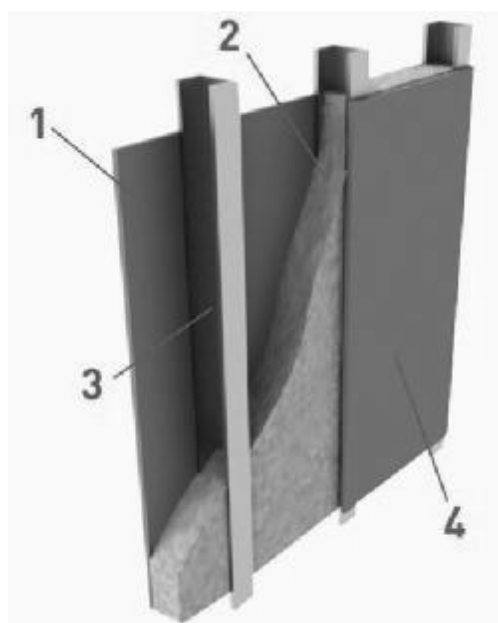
Утепленная перегородка: 1, 4 – листы из гипсокартона, 2 – тепловая изоляция, 3 – каркас из металлического профиля
